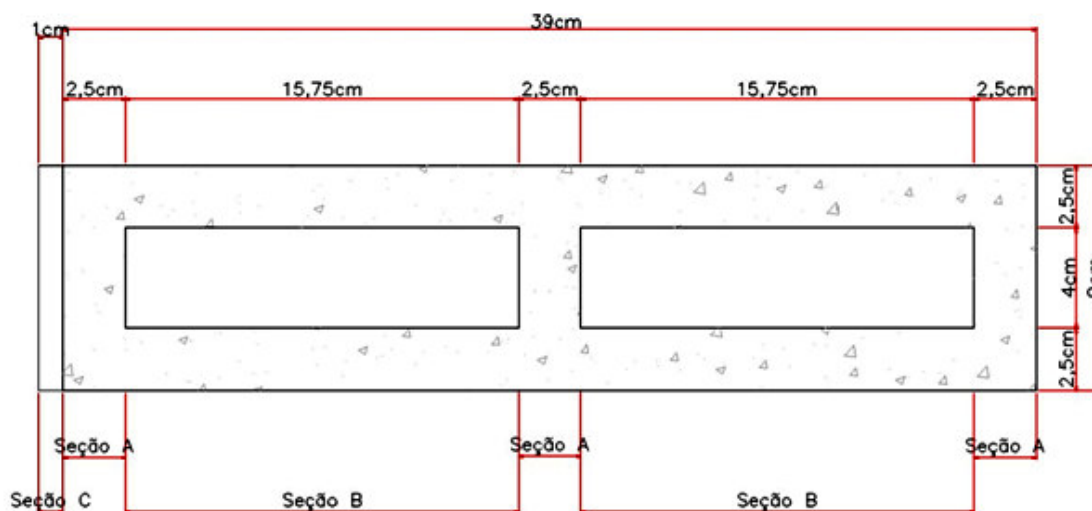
Dimensões e divisão das seções do bloco de concreto testado
